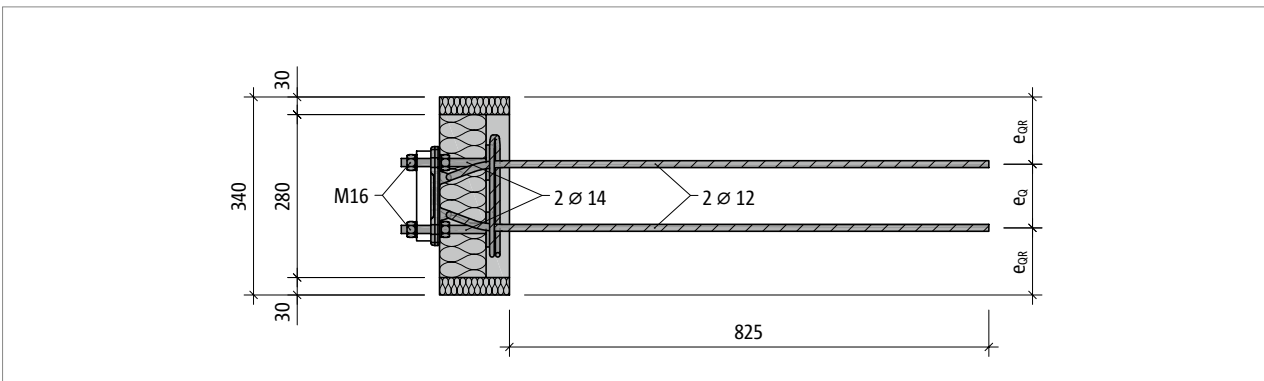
Schöck Isokorb® RT Typ SQ-V3: Produktgrundriss
